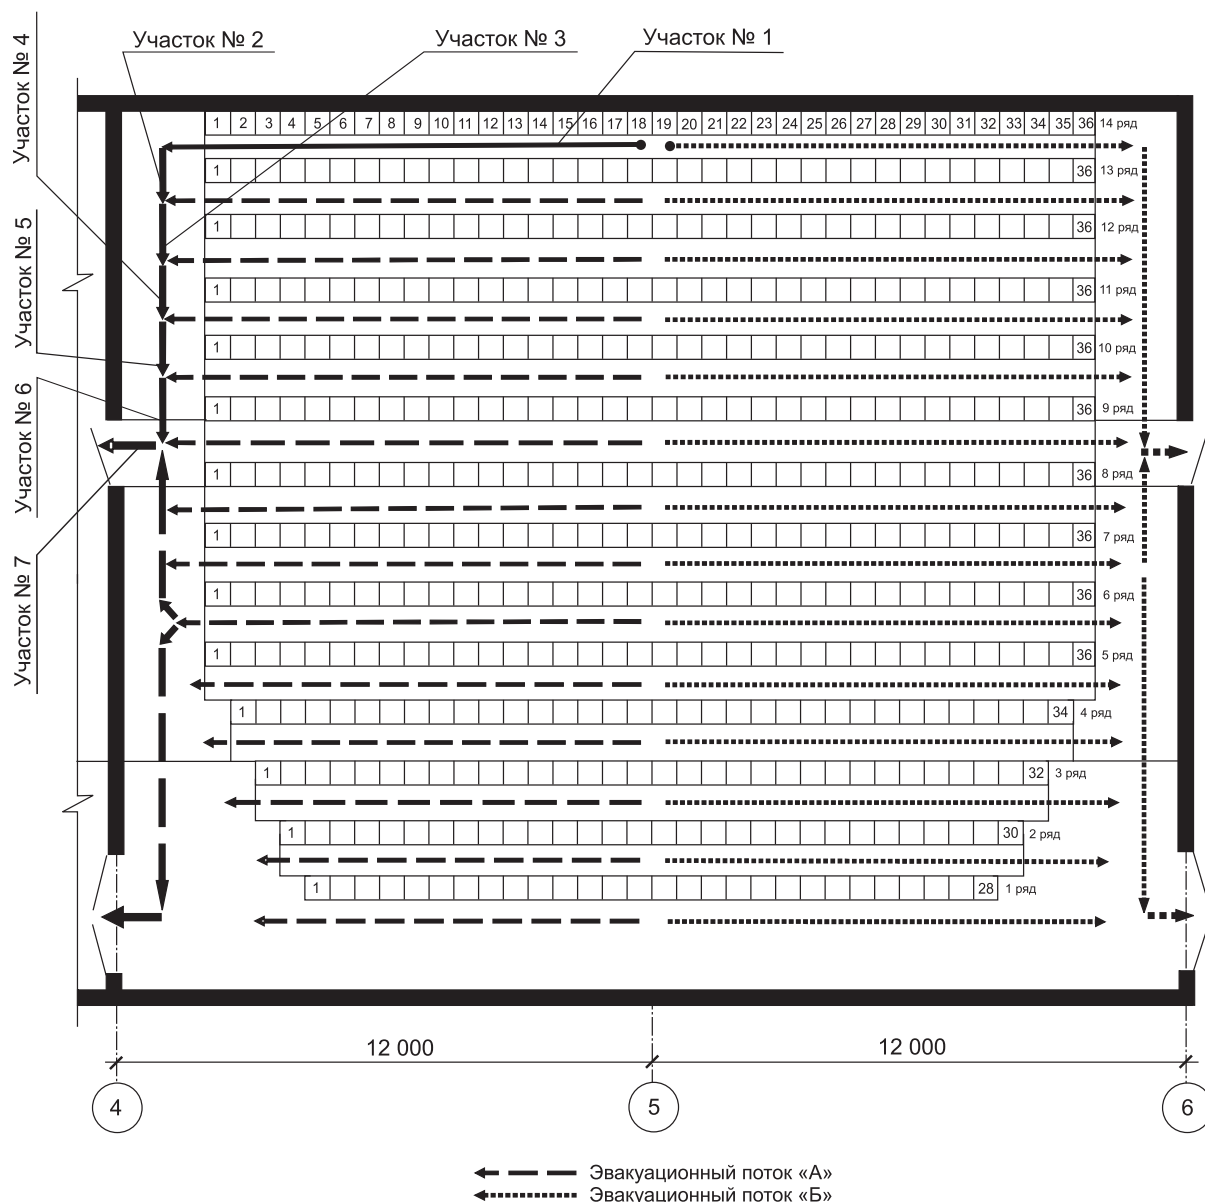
Схема зрительного зала с расчетной схемой эвакуации
